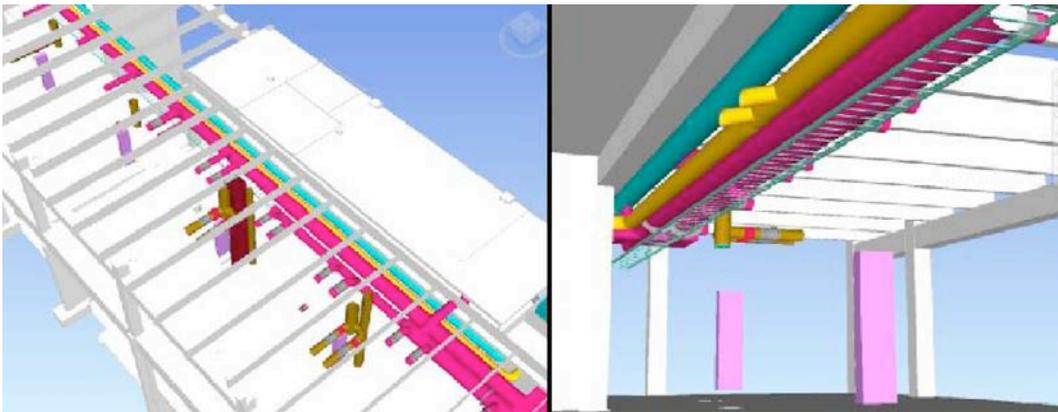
Ejemplo: Imágenes de las redes horizontales y el BIM Estructural en la fase de desarrollo del diseño.
